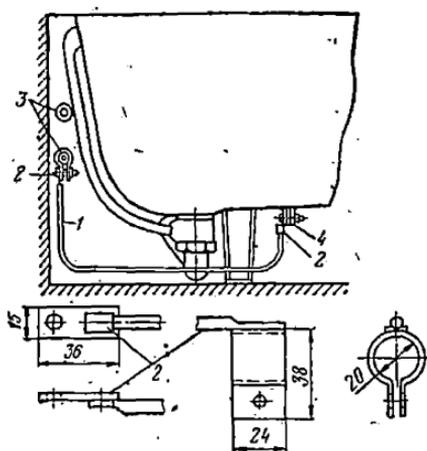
Монтажная схема присоединения заземляющего проводника к ванне
